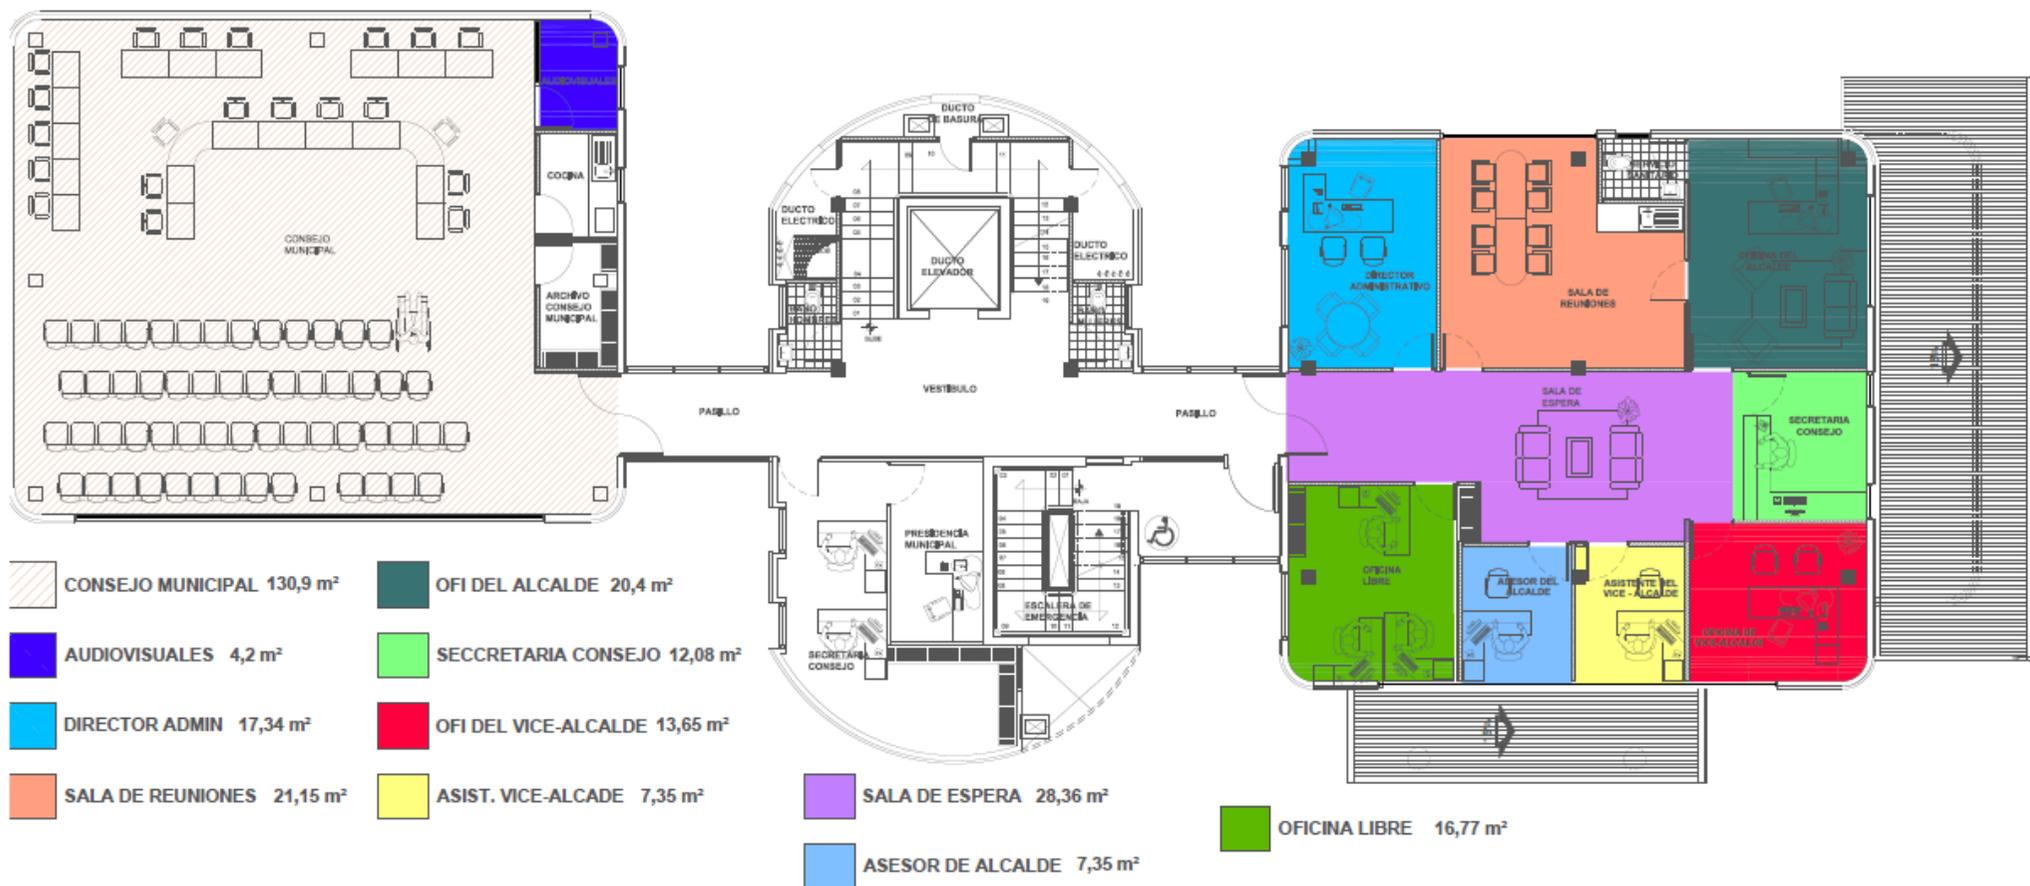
Distribución de oficinas en planta arquitectónica, nivel 03
